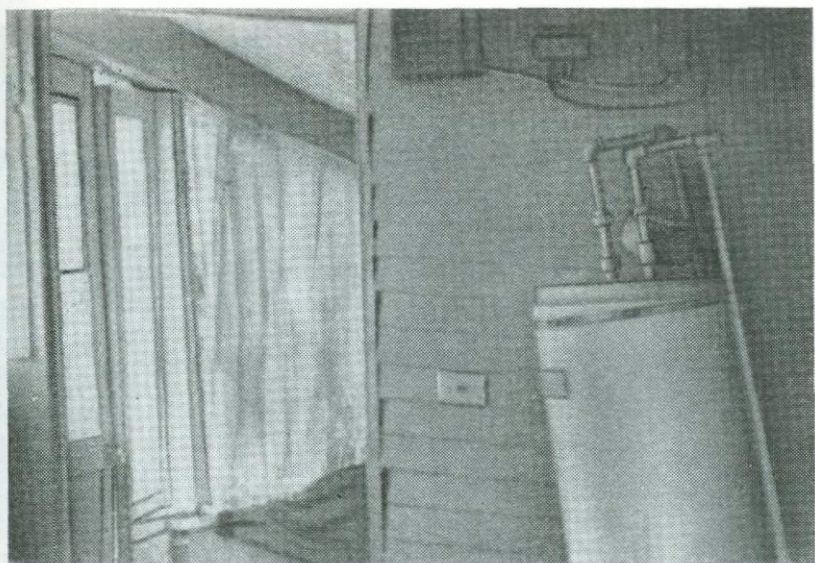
Плохие поперечные связи и тяжелая крыша вызвали перекос каркаса дома в Сан-Фернандо
